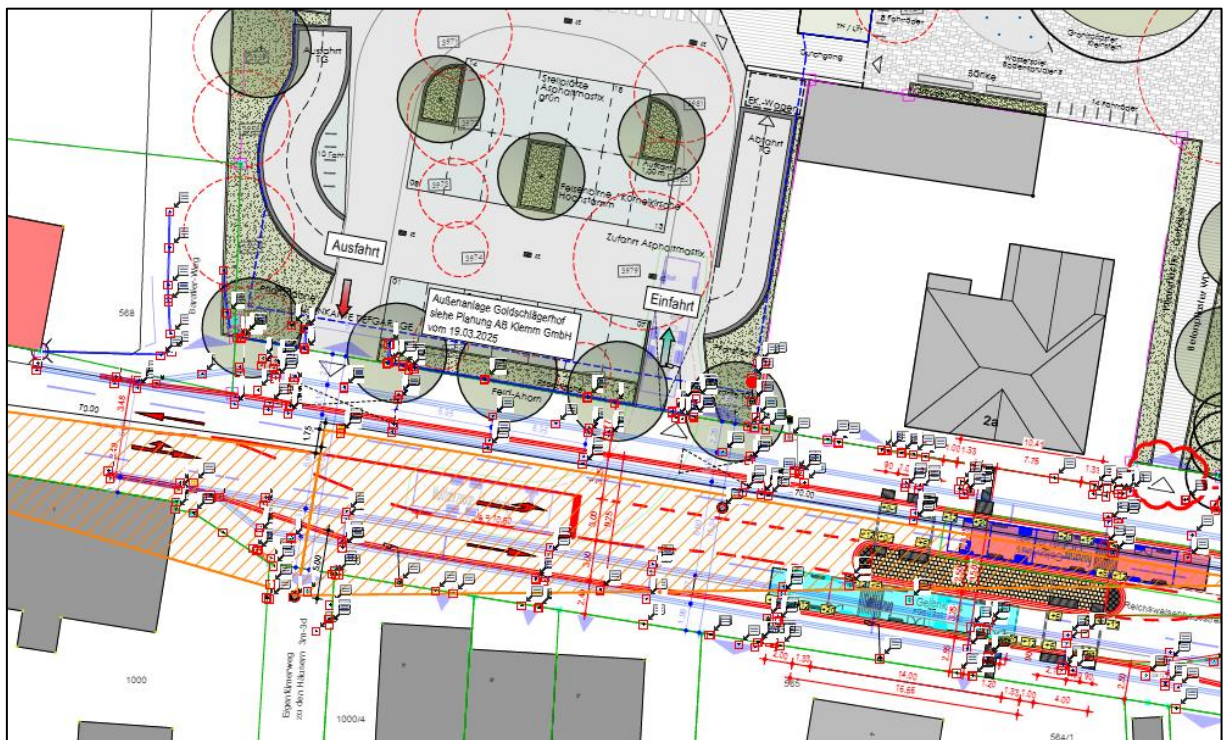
Lageplan Erschließung Goldschlägerhof¹
